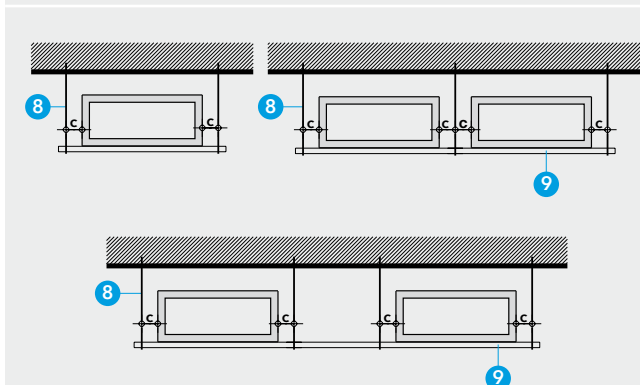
Detail C - Abhängung und Auflagerung des Stahlblechkanals
